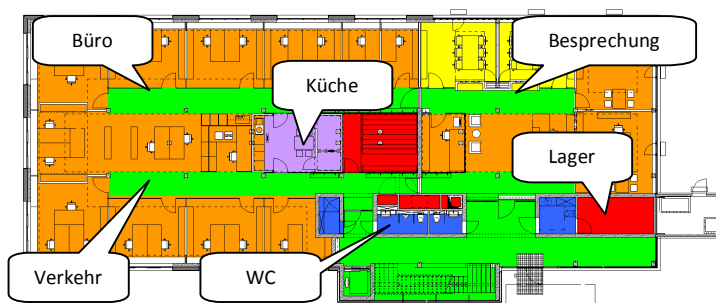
Grundriss Regelgeschoss mit Zonierung, Geb.2
